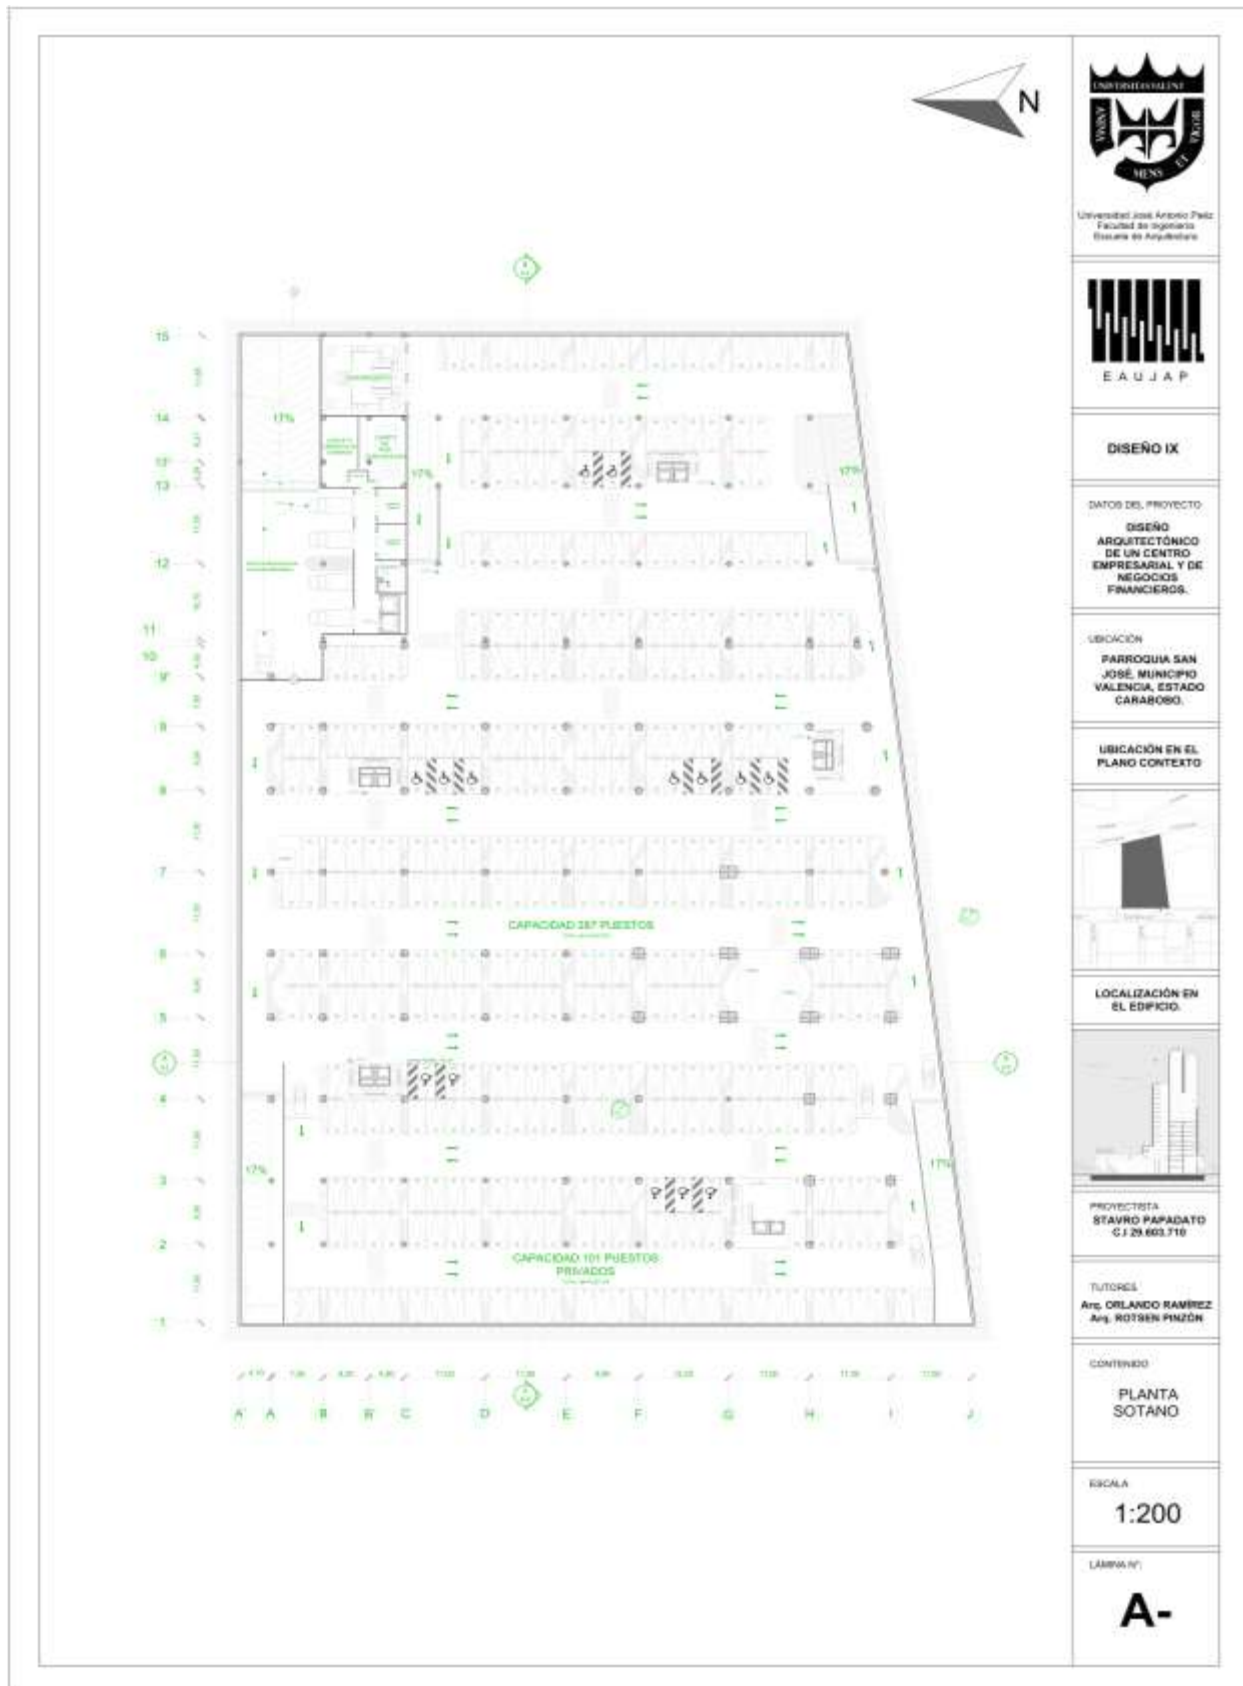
A-1 Planta Sotano Fuente: El Autor (2023)
